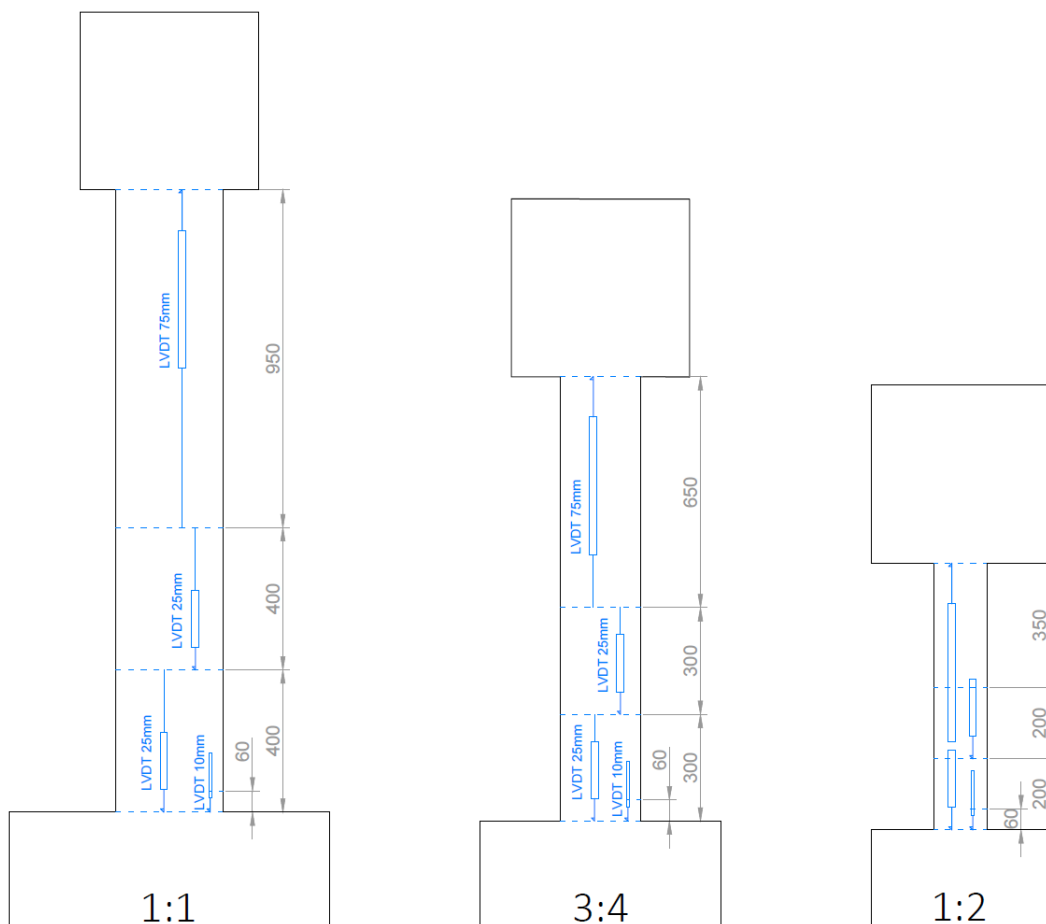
Plans pour le placement des LVDTs, vue de côté - Unités [mm]
